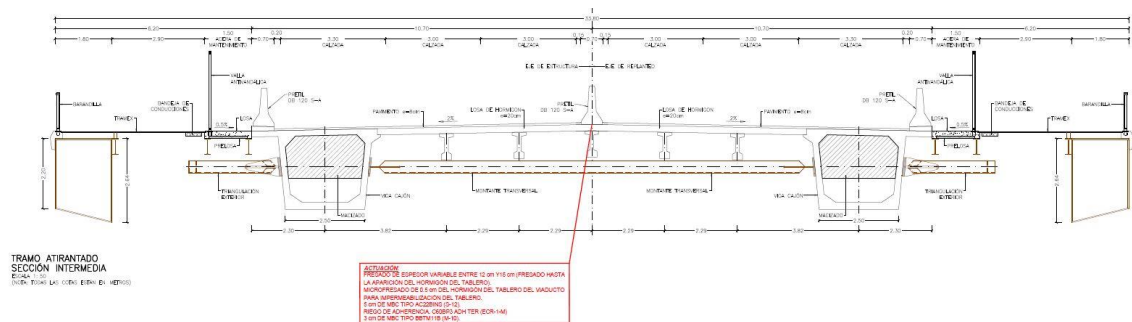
Imagen de la sección tipo proyectada en tramo atirantado
